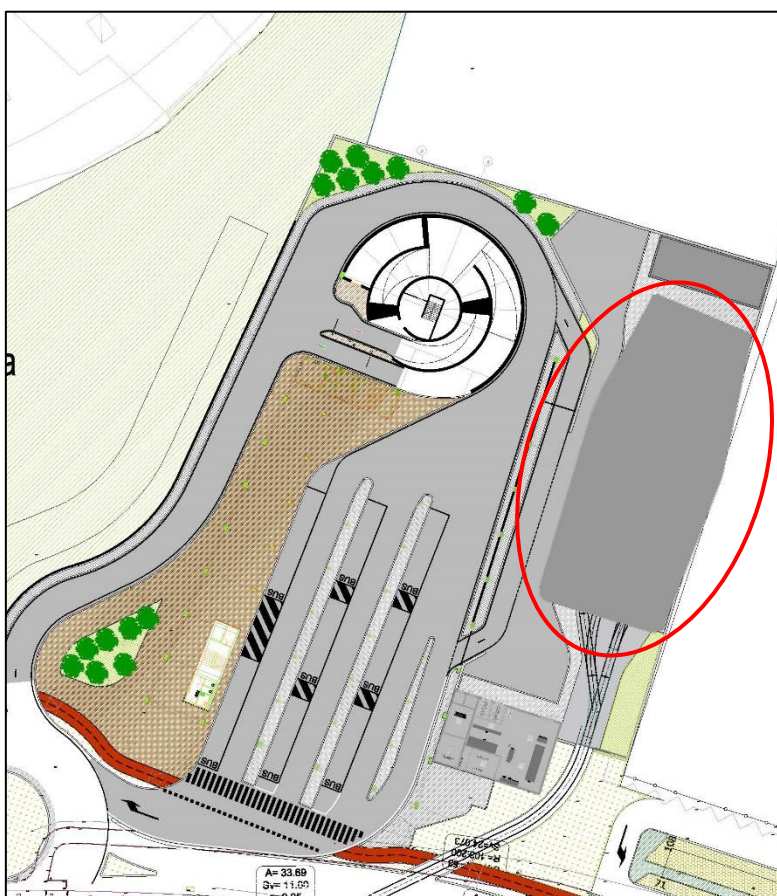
Individuazione dell'edificio di nuova costruzione
